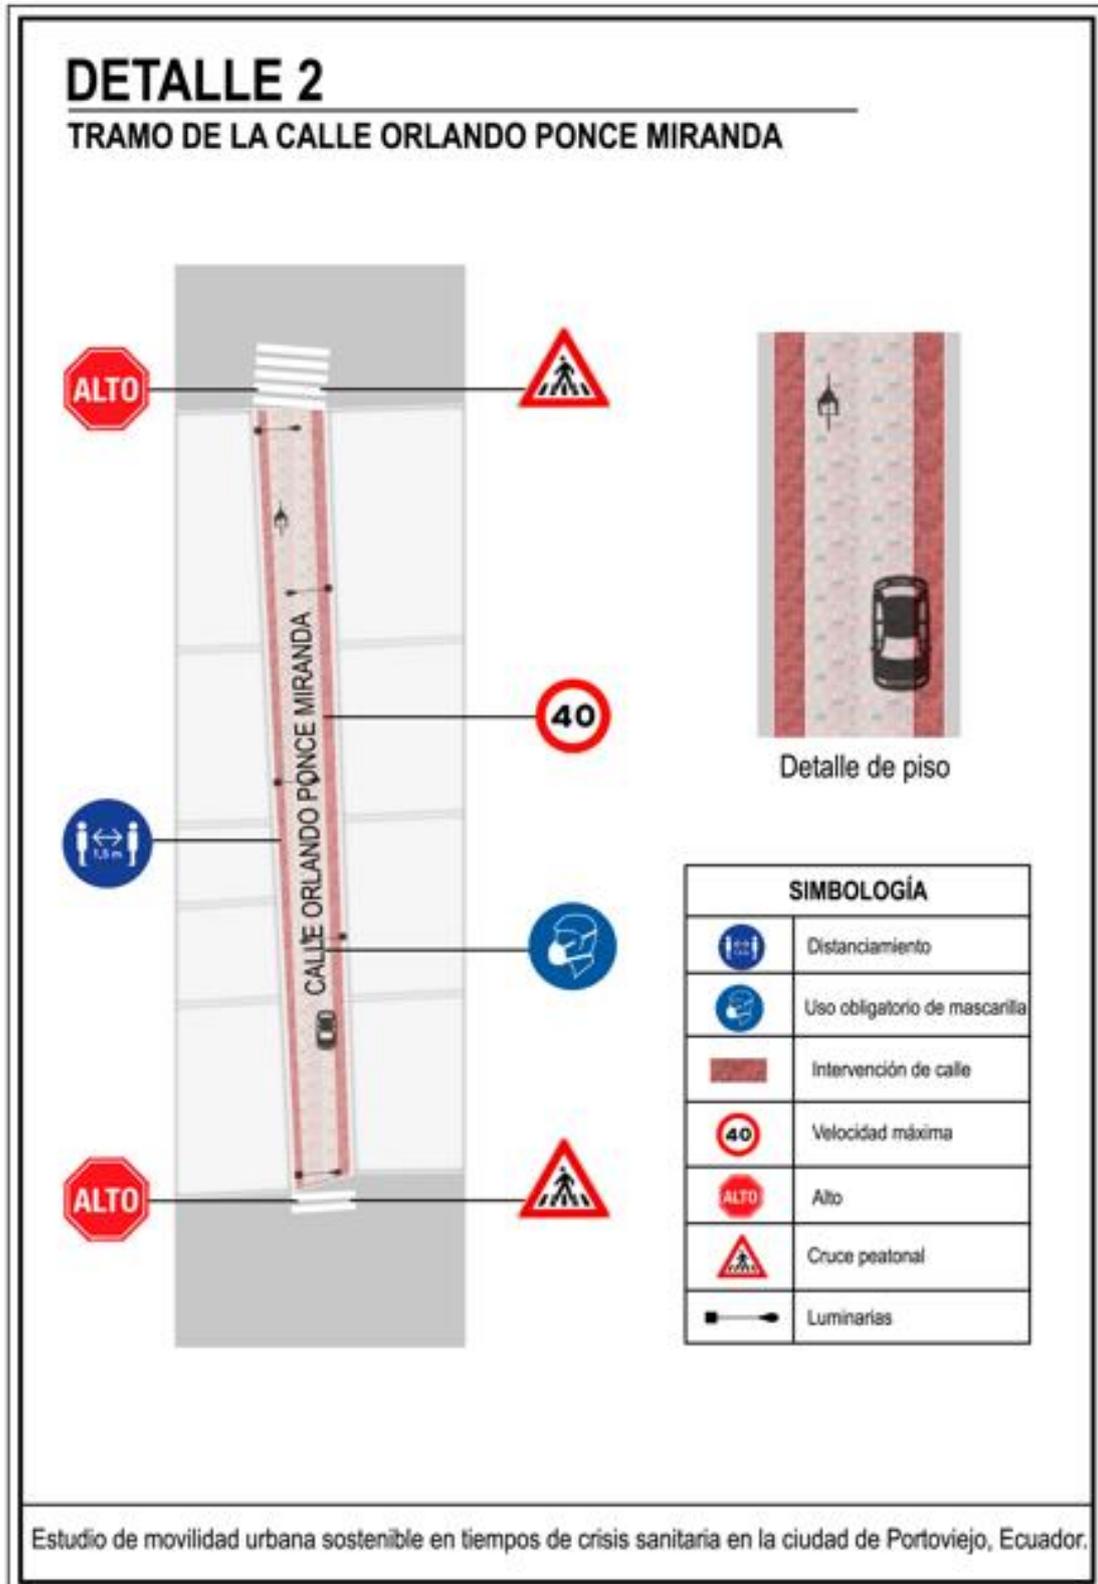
Detalle de implantación B-B, en los puntos establecidos para la propuesta
